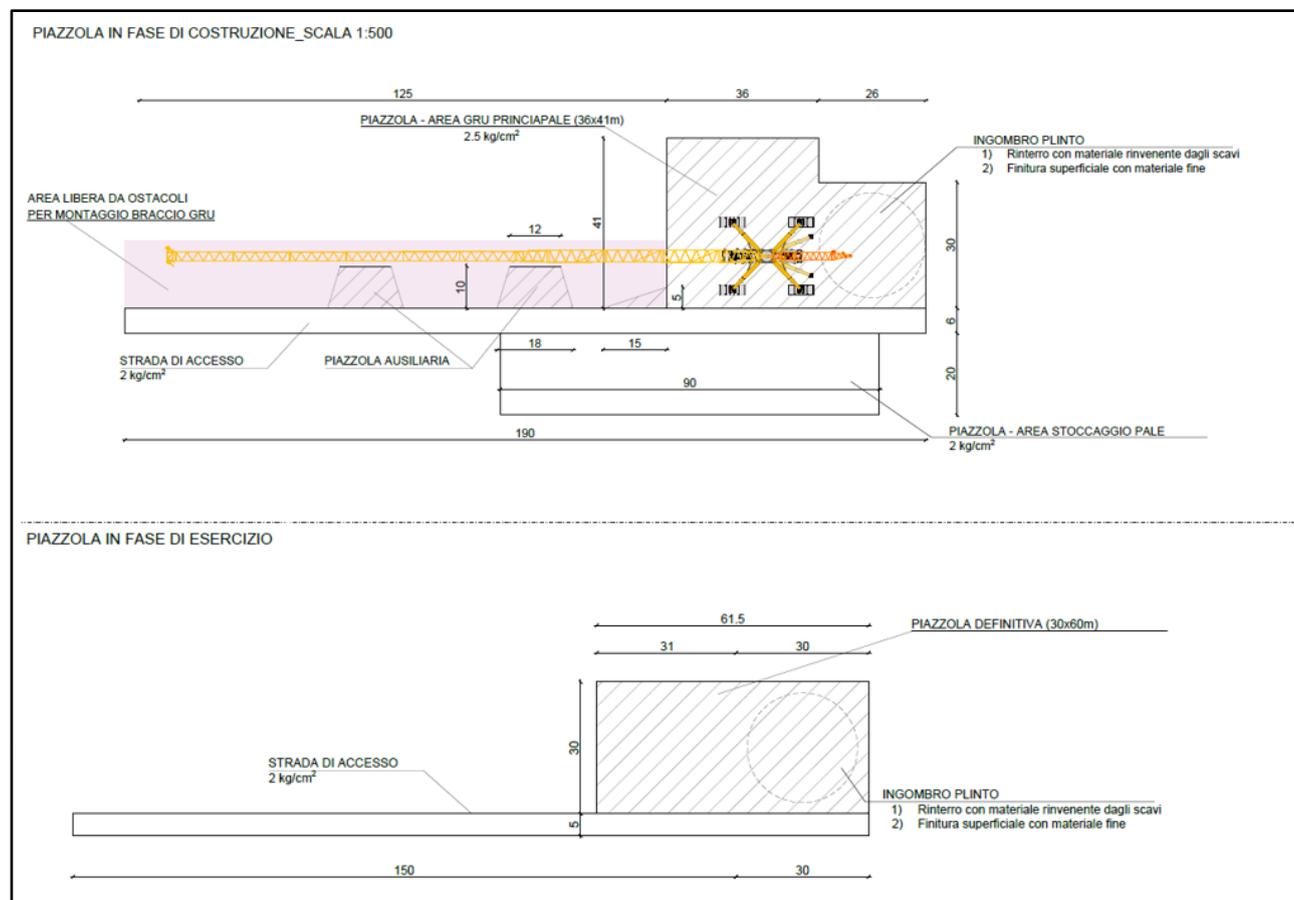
Planimetria piazzola tipo per la fase di installazione e fase di esercizio e manutenzione
